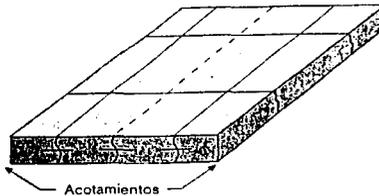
CARACTERÍSTICAS DE LA SECCIÓN.
